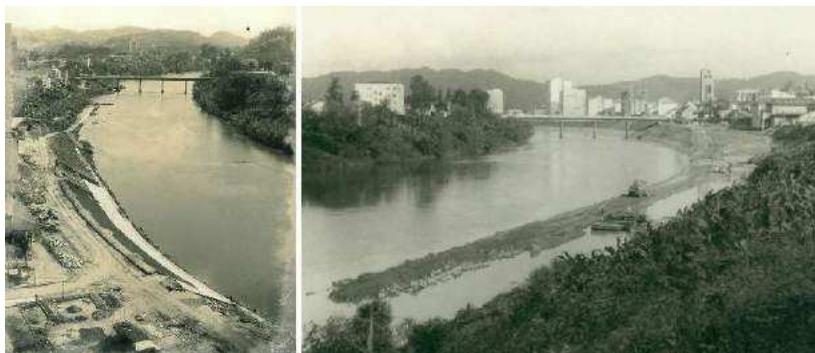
Imagem da construção da primeira parte da Beira-rio.
